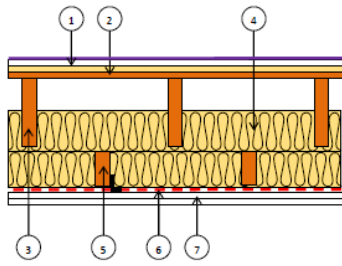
Cas du plancher solivé simple ossature avec plafond suspendu 2 BA13 et chape liquide.
